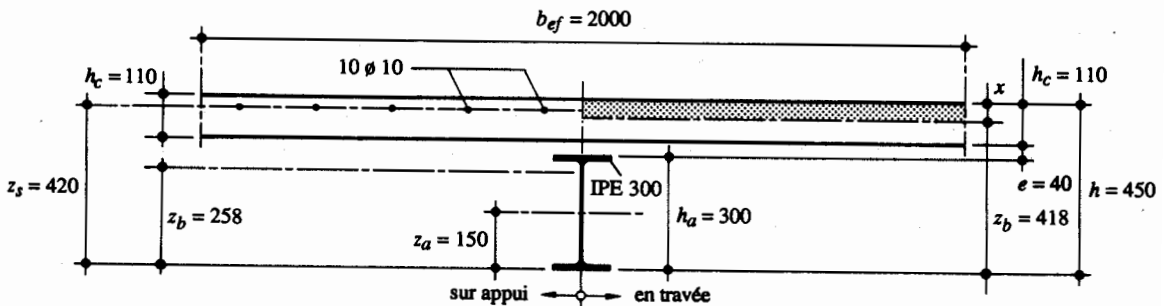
Section mixte en travée et sur appui (calcul plastique).
